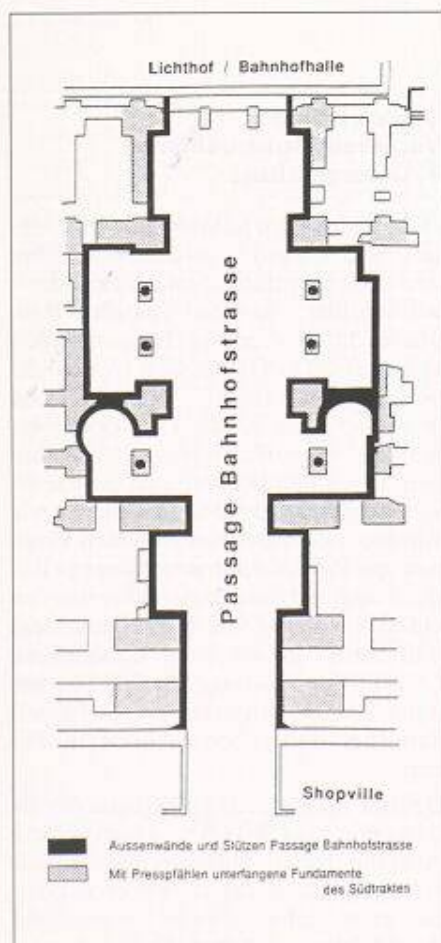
Grundriss der Passage Bahnhofstrasse (Fundamente des Südtraktes und neue Aussenwände der Passage)
